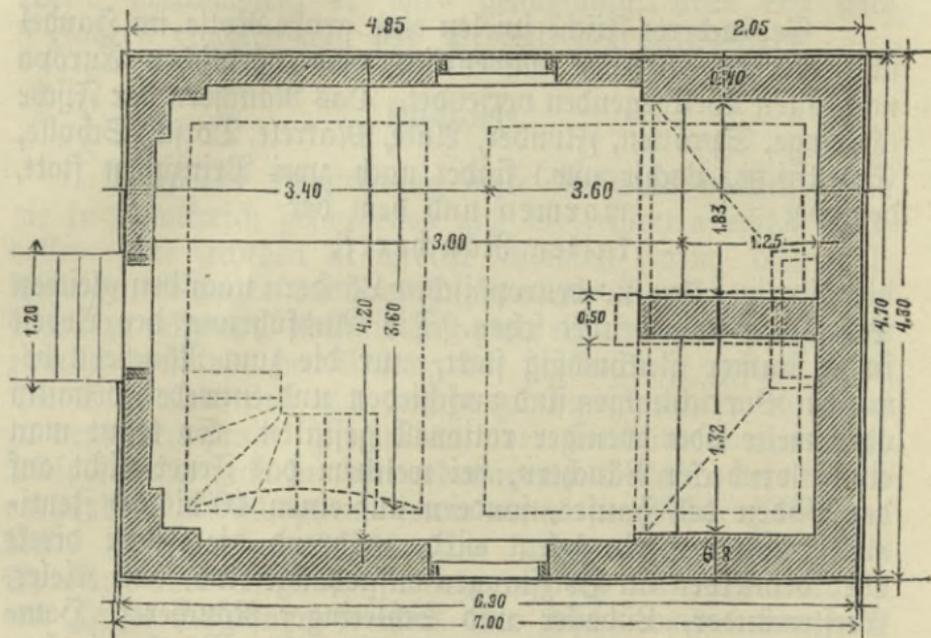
Ellerbecker Räucherhaus mit drei Herden (Grundriß).
